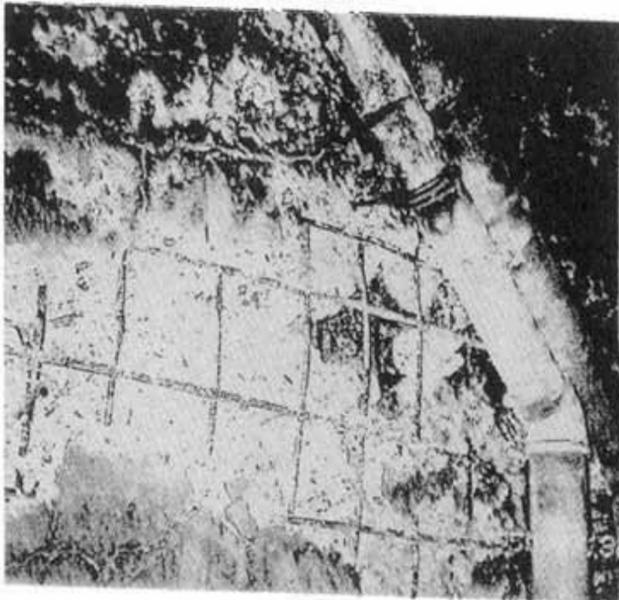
三宮第2駐車場・スラブのコンクリート剥落・鉄筋露出(被害タイプA)
